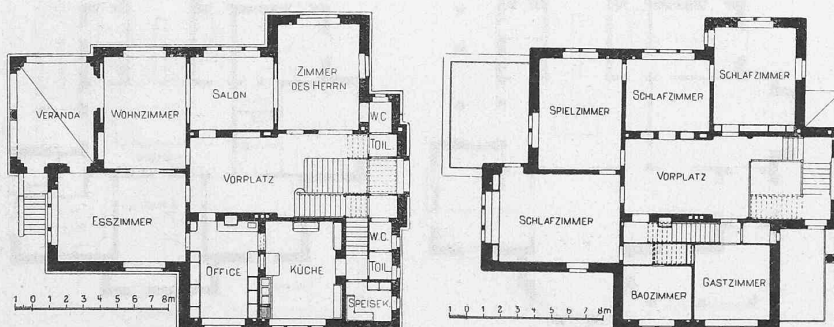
Grundrisse vom Erdgeschoss und I. Obergeschoss der Villa E. Huber-Stockar in Zürich V. — Masstab 1:400.
